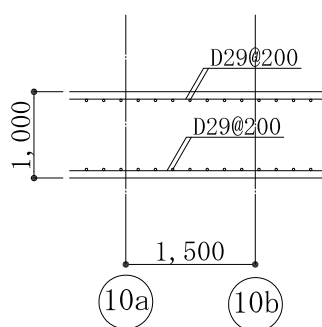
基礎スラブの配筋図 (1A 通り, 単位: mm)
